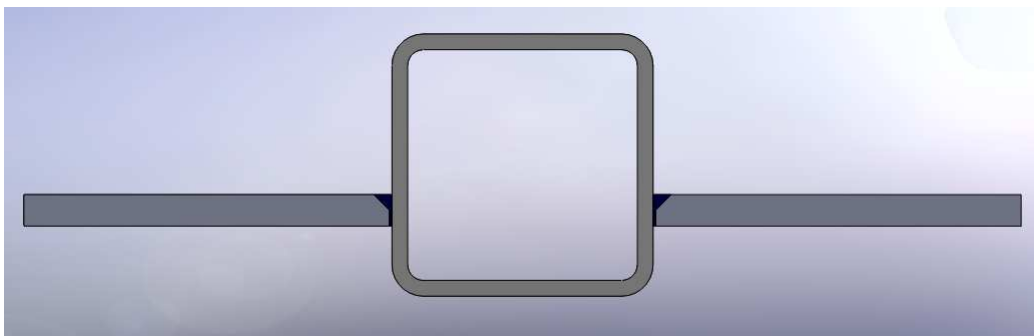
Soldadura da chapa afastada da face do pilar
